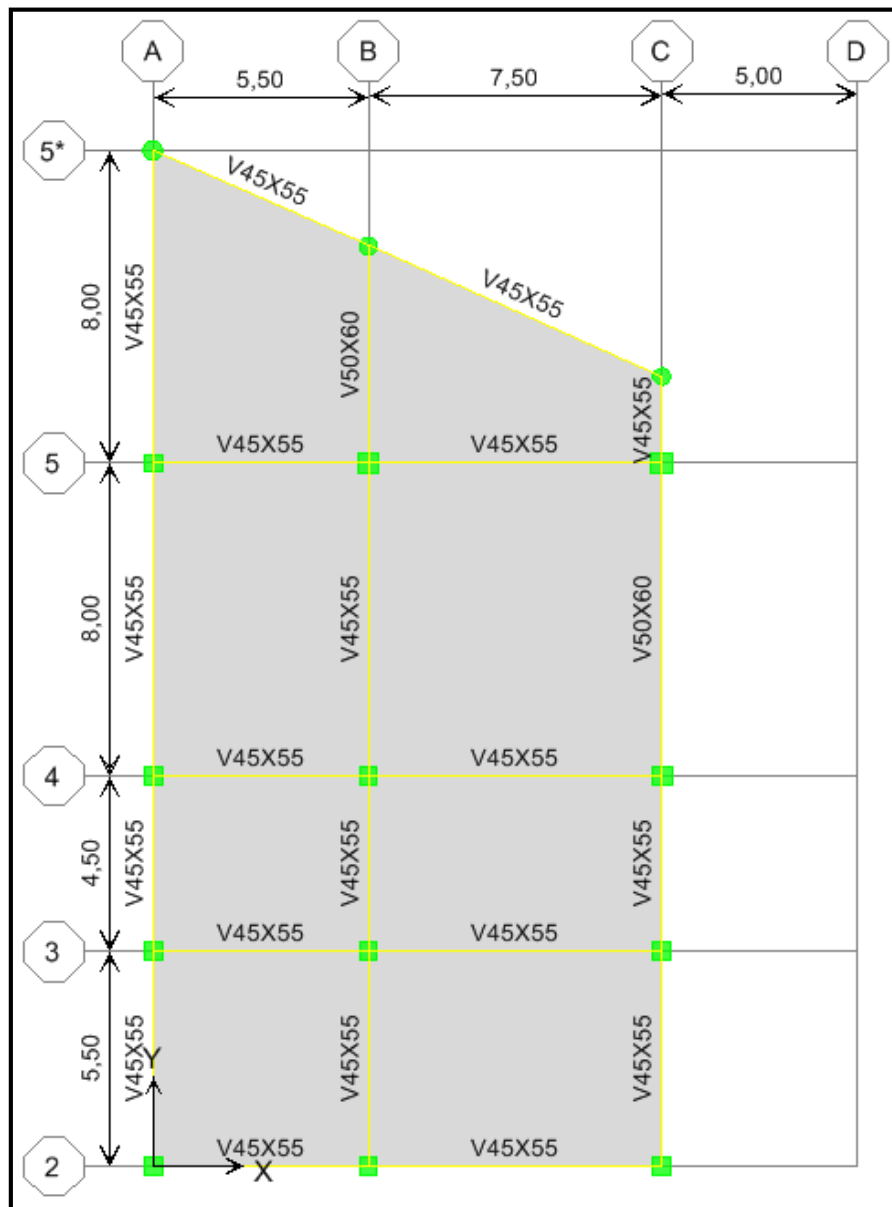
Secciones Finales de Vigas (Nivel Techo)
